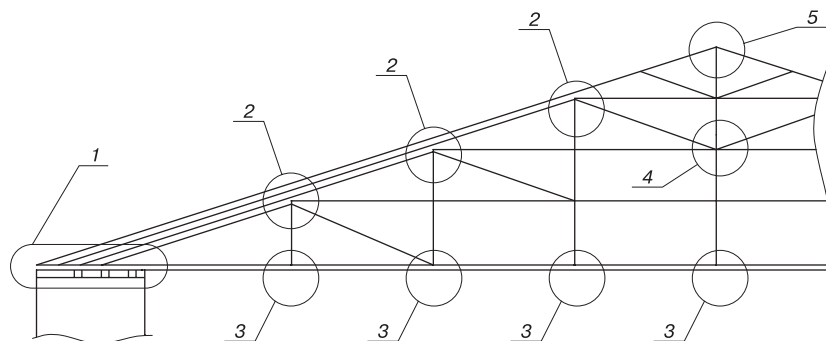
Геометрическая схема фермы: 1 – опорный узел (рис. 2); 2 – узел сопряжения верхнего пояса и решетки панели (рис. 3); 3 – узел сопряжения нижнего пояса с элементом решетки; 4 – узел сопряжения элементов решетки (рис. 4); 5 – коньковый узел
